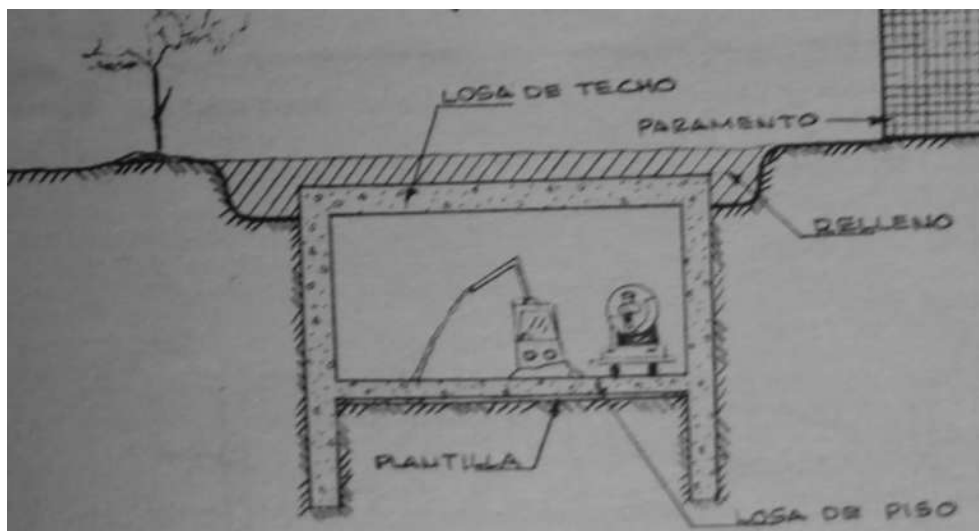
Túnel falso con muros a base de pilas de concreto
